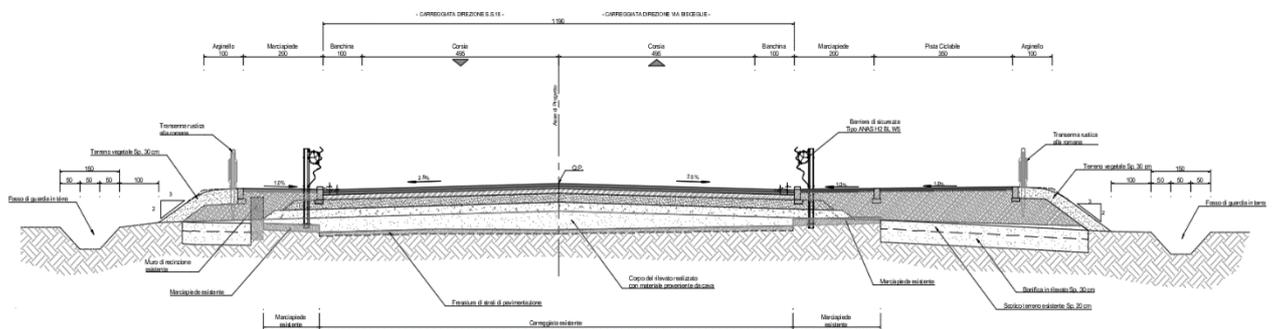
Sezione tipologica dell'Asse B – strada Vicinale Padula
